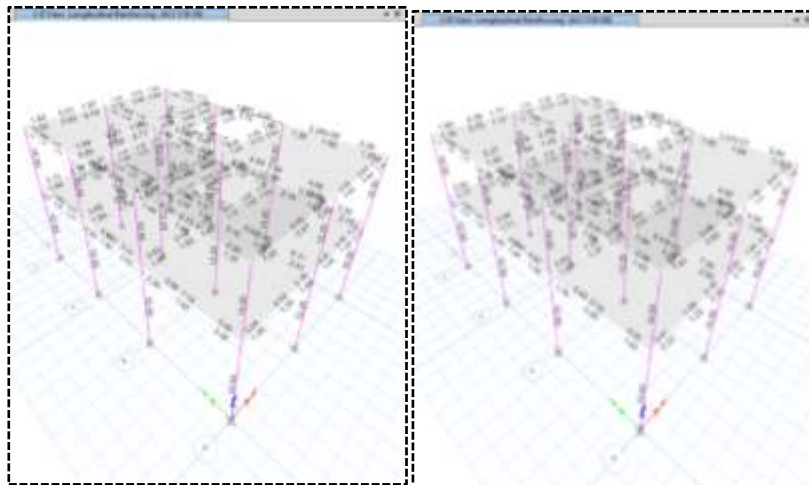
Diseño estructural, refuerzo longitudinal de la viga y columna de una vivienda unifamiliar utilizando concreto patrón y concreto con adición del 1%CHH.
